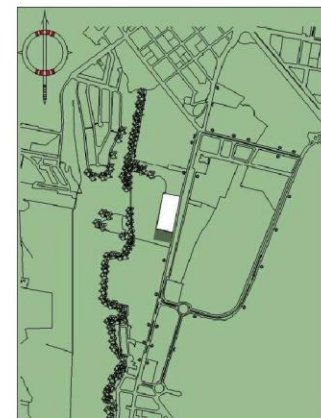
Soleamiento 08 de Junio a las 12 p.m.
